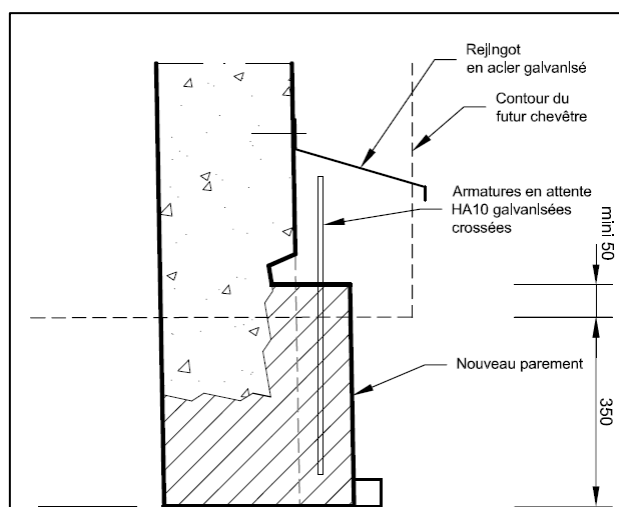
is : Dispositif de protection contre les coulures dans l'attente de la construction des nouveaux chevêtres
